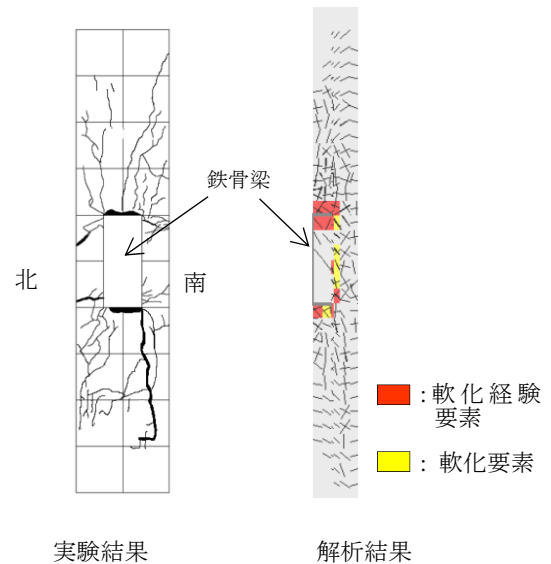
梁接続面ひび割れ図 (RCS-15)
